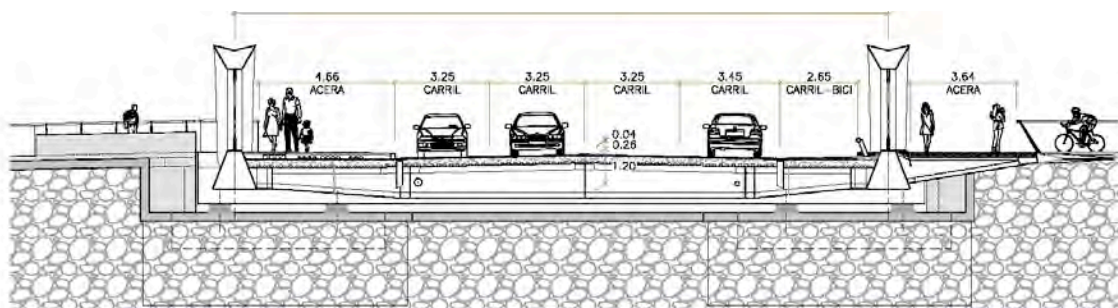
Sección transversal. Vista hacia el estribo de la margen izquierda.
